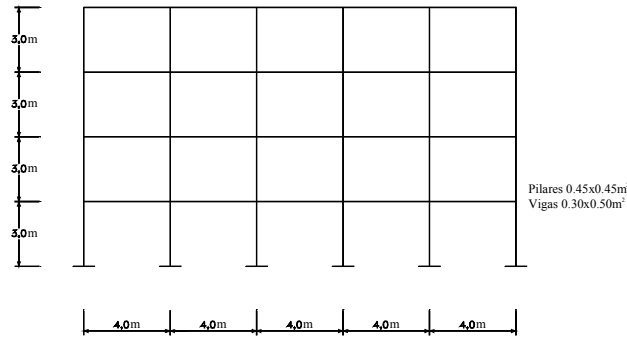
Secções transversais dos alinhamentos resistentes da direcção Y das estruturas de 4 pisos.
